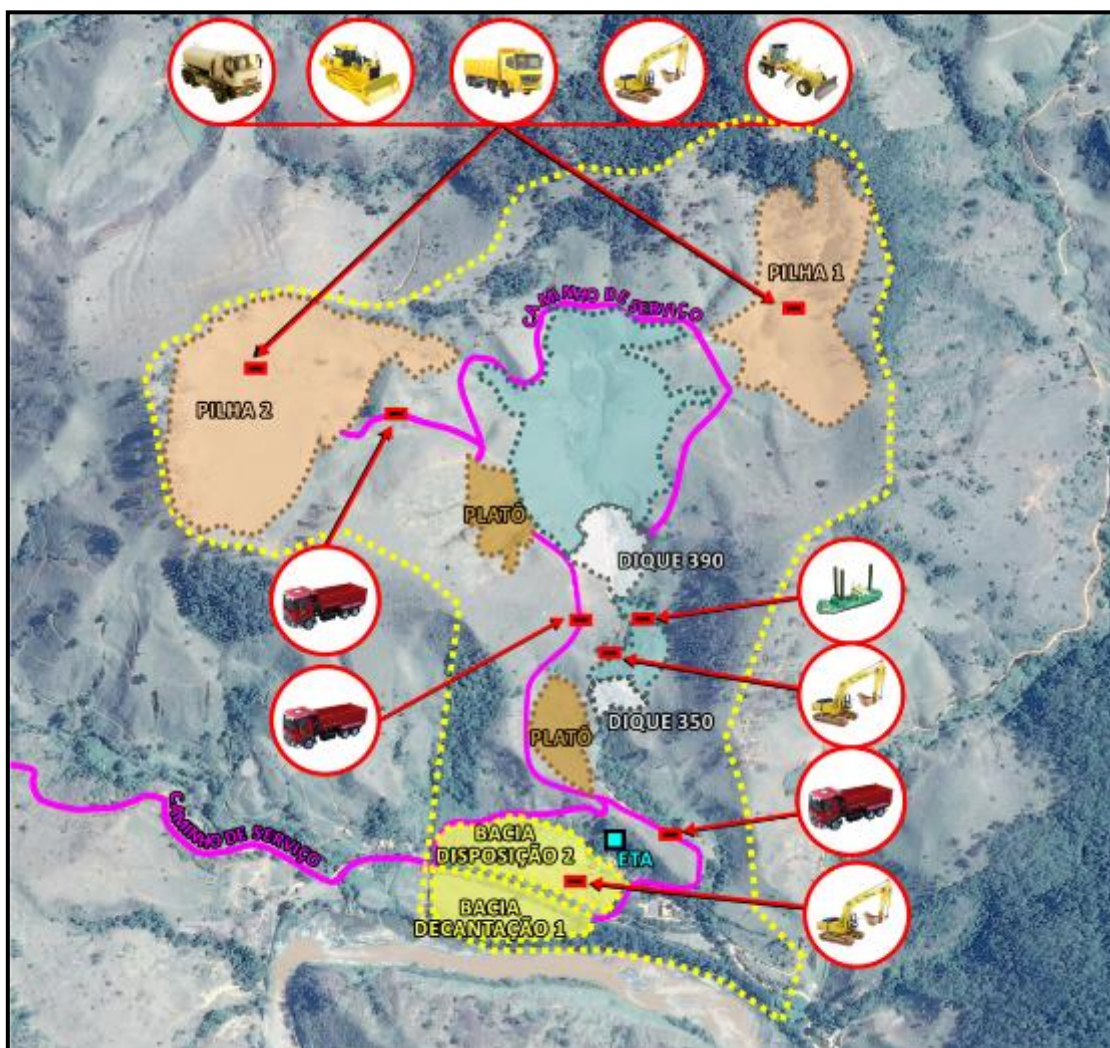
Escavação Mecanizada / Dragagem para Fazenda Floresta
